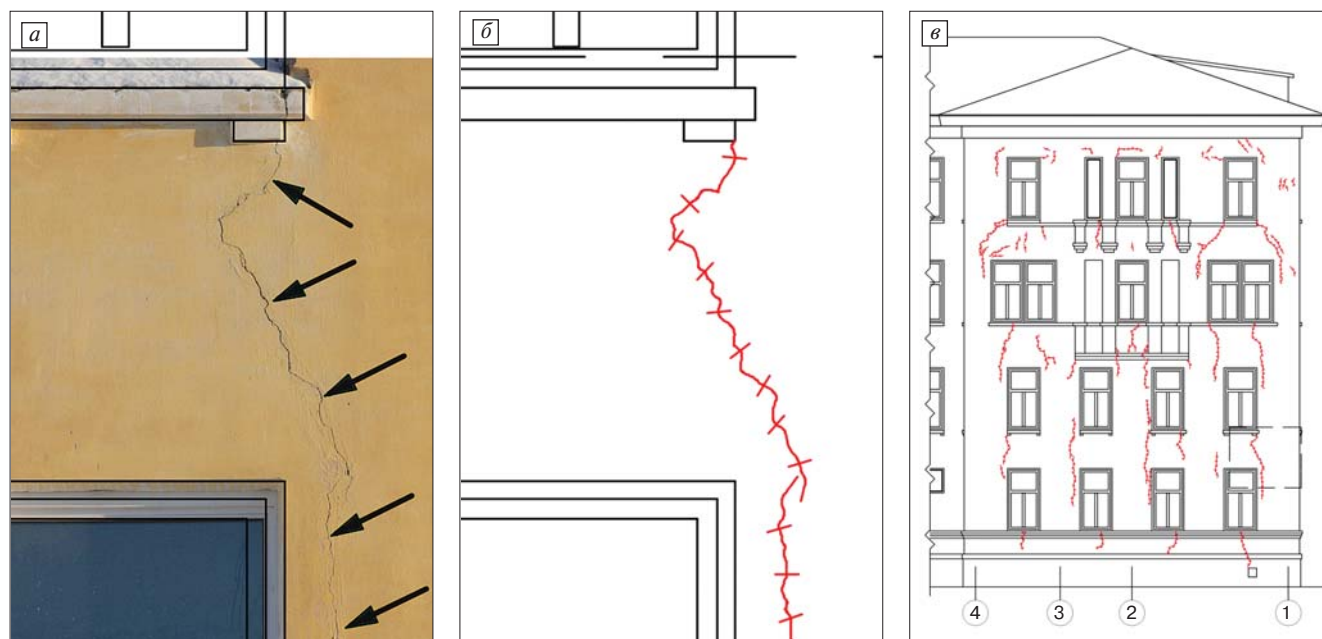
а – фотография участка с трещиной фоновым изображением размещена на рабочем листе ArchiCad исполнительной схемы фасада; б – обводка трещин; в – исполнительная схема трещин на фасаде
